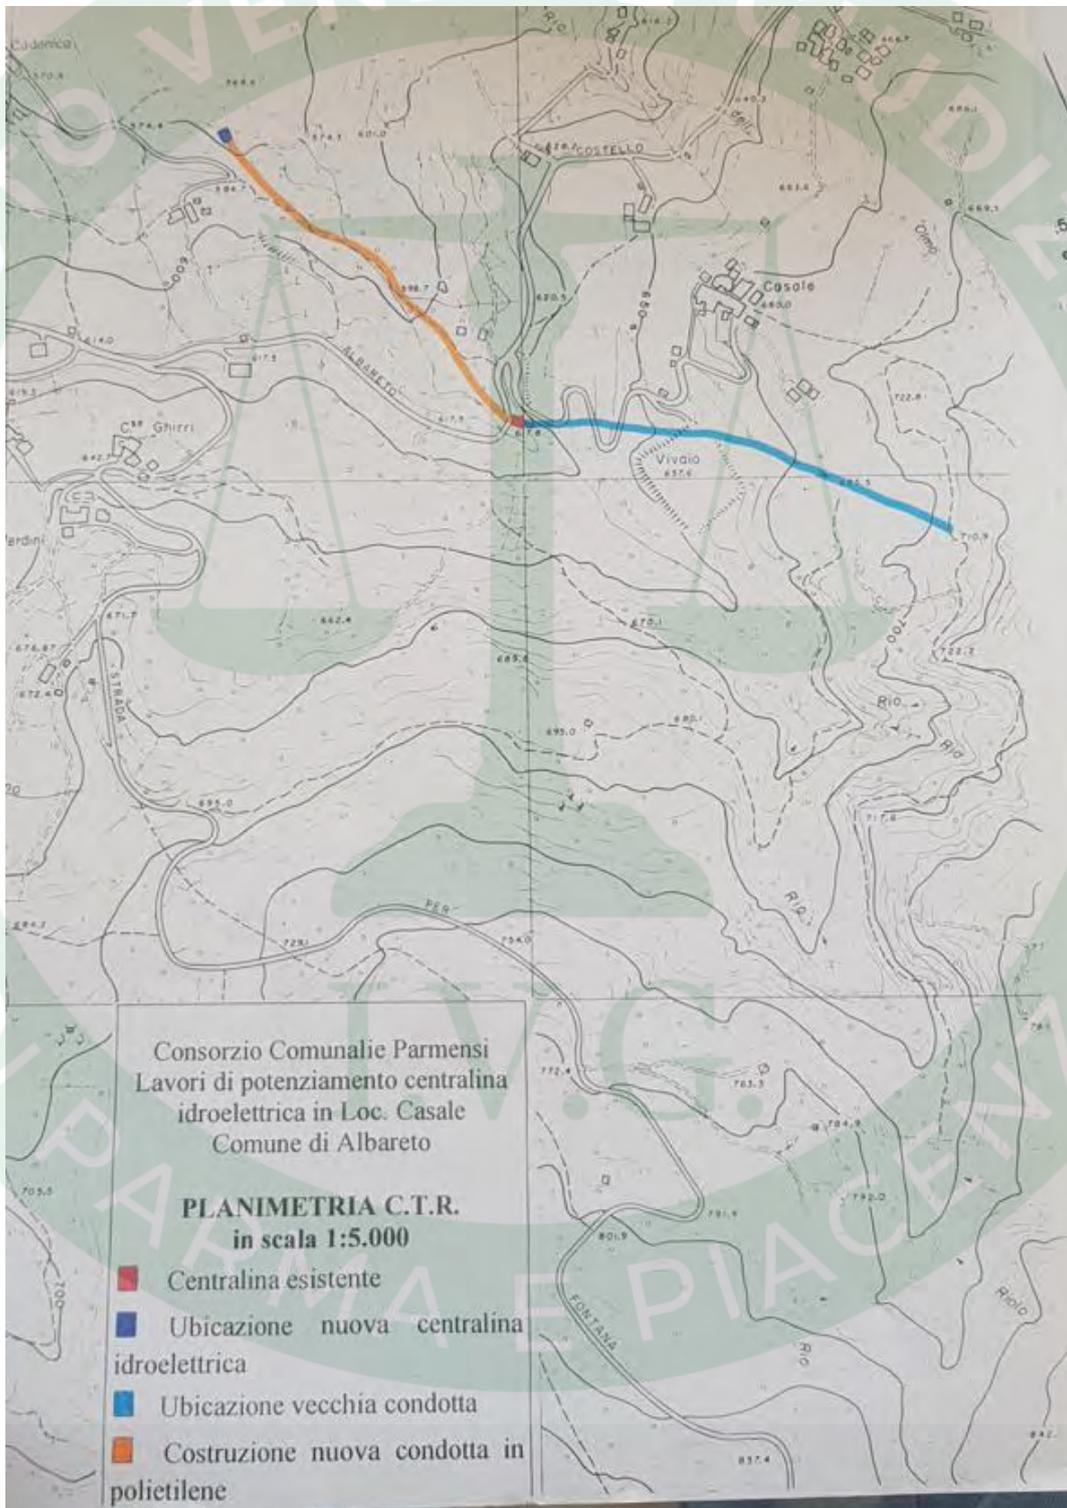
Schema generale d'impianto con rappresentazione della condotta forzata e della centralina preesistente
